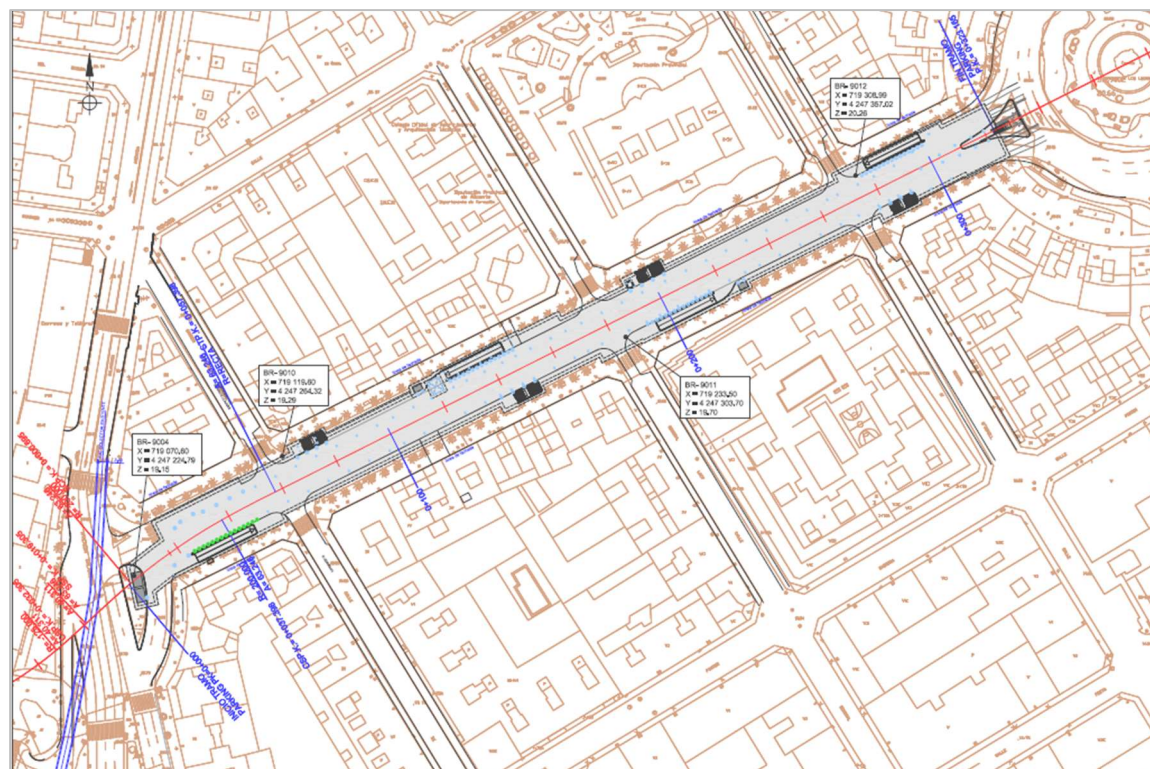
Planta Tramo 0B. (Fuente: Proyecto Tramo 0B)
